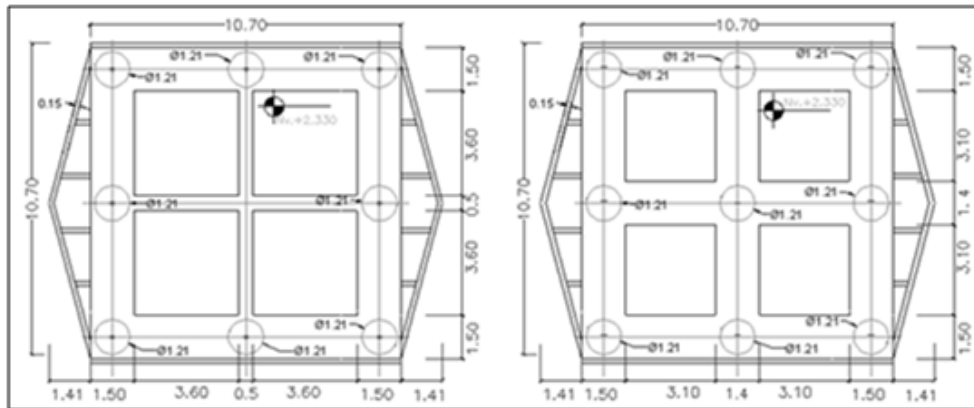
16: Vista en Planta de las Zapatas del tramo central (CEE, 2007)
